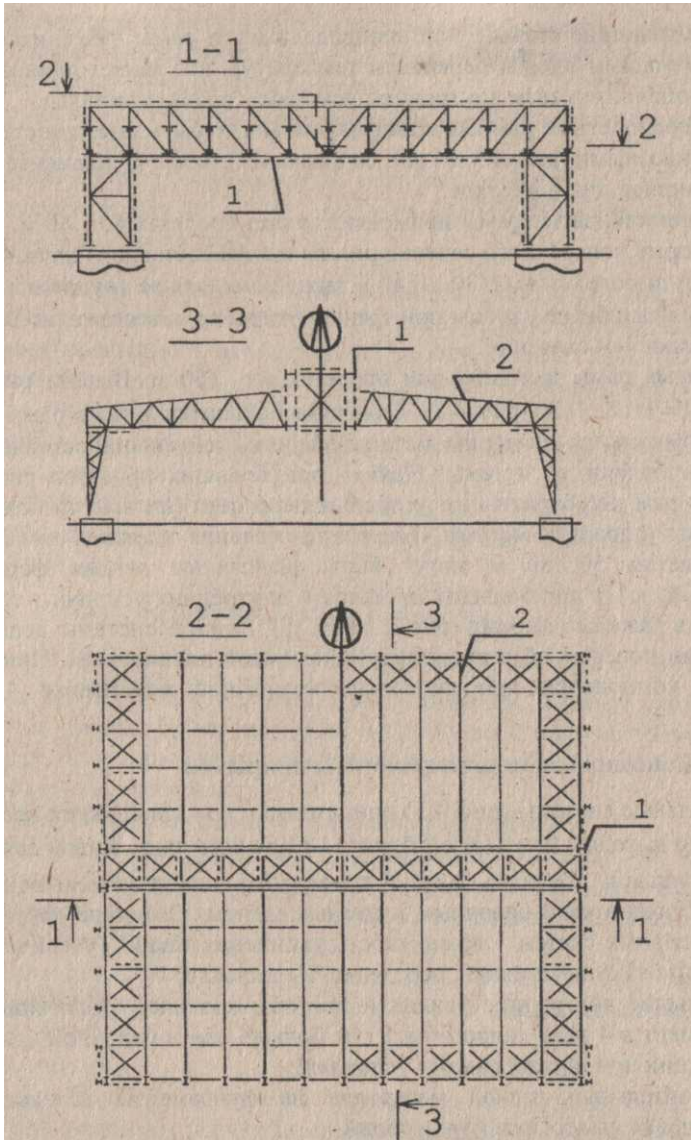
Продольно-поперечная компоновка рам каркаса 1 - блок продольных рам, 2 - поперечные полурамы
